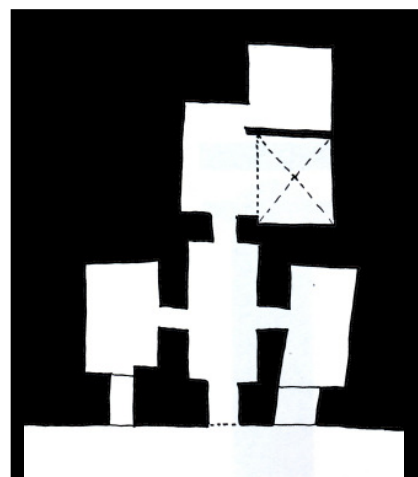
Planta esquemática de habitação subterrânea com pátio interno
